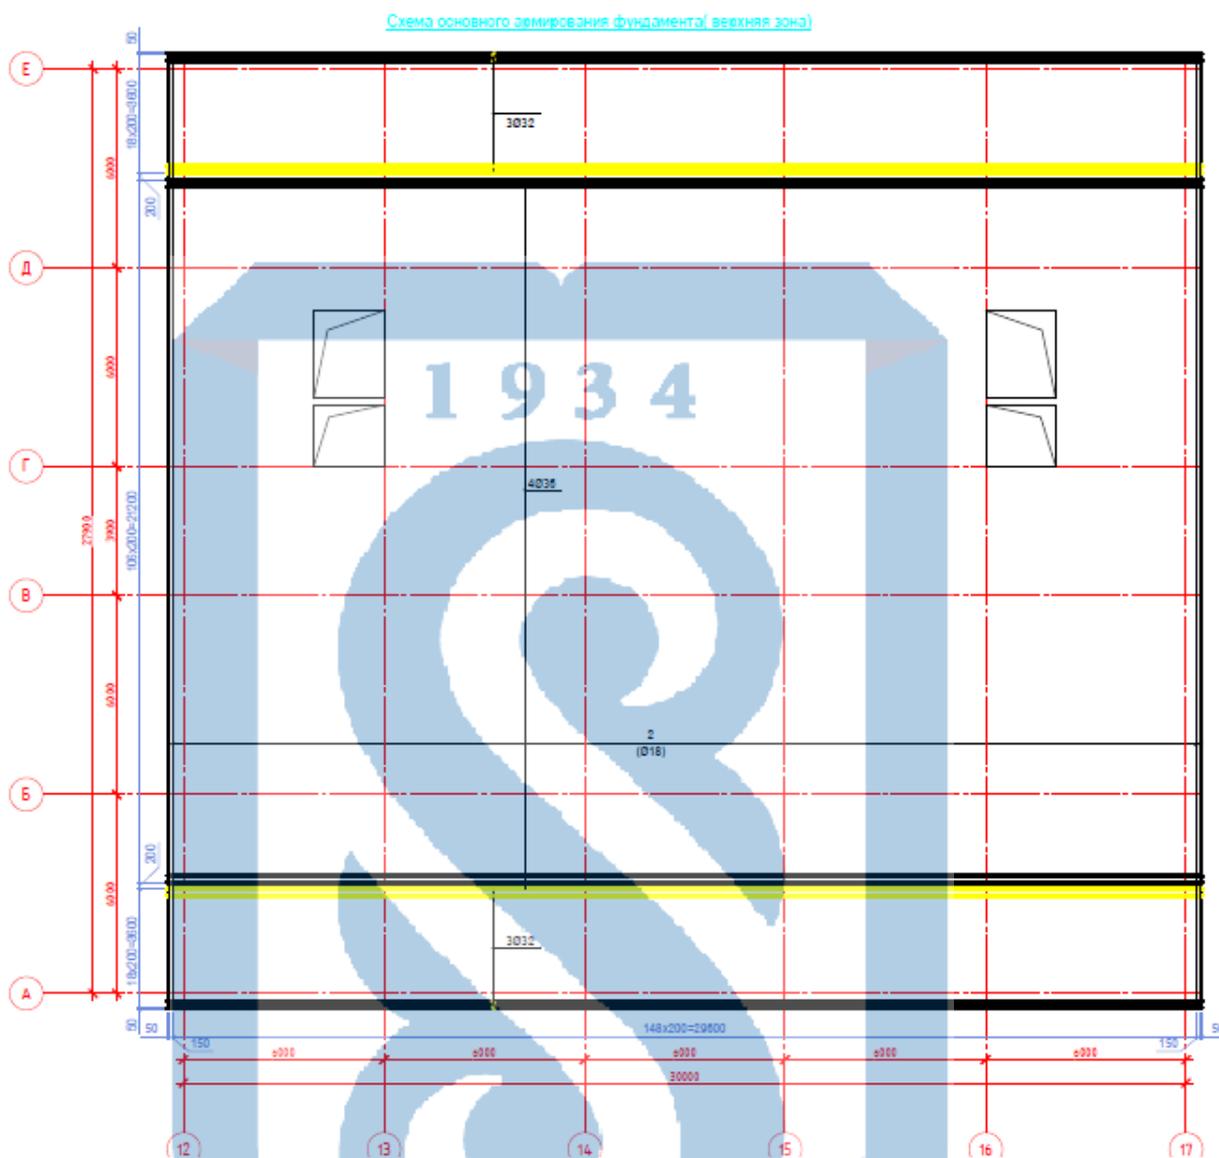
Схема основного армирования нижней и верхней зоны
